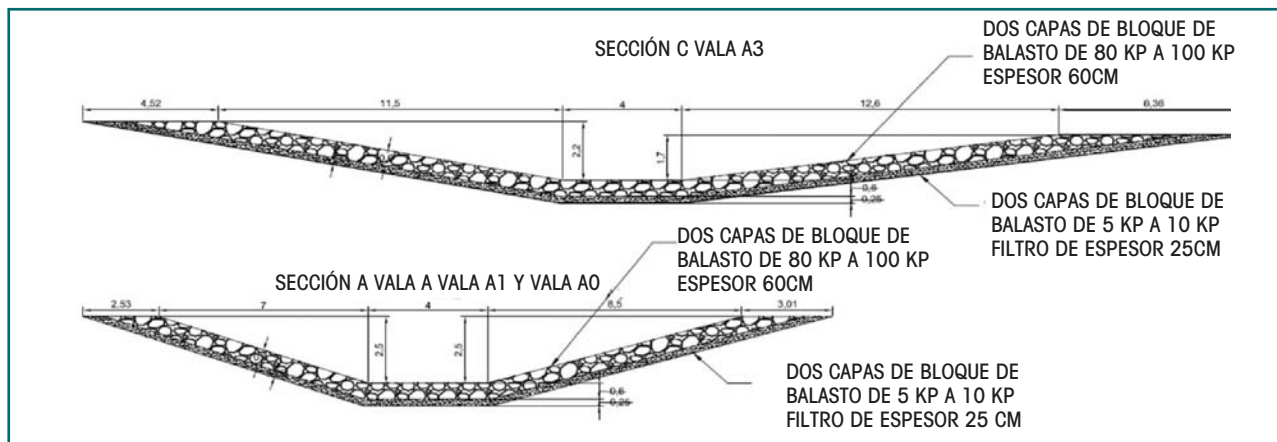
Sección planteada para los canales de desagüe procedente de los planos del proyecto "Fortalecimiento del Municipio de Beira para la planificación y diseño de infraestructuras de defensa litoral y drenaje"/Proposed section of the drainage channels incorporated in the project "Reinforcement of the Beira municipality - planning and design of coastal defence and drainage infrastructure".
